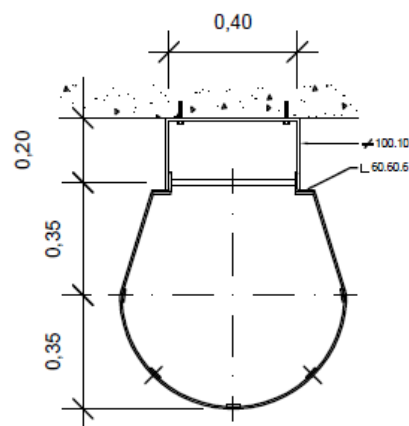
Vista en planta de la escalera de gato proyectada (mediciones).
